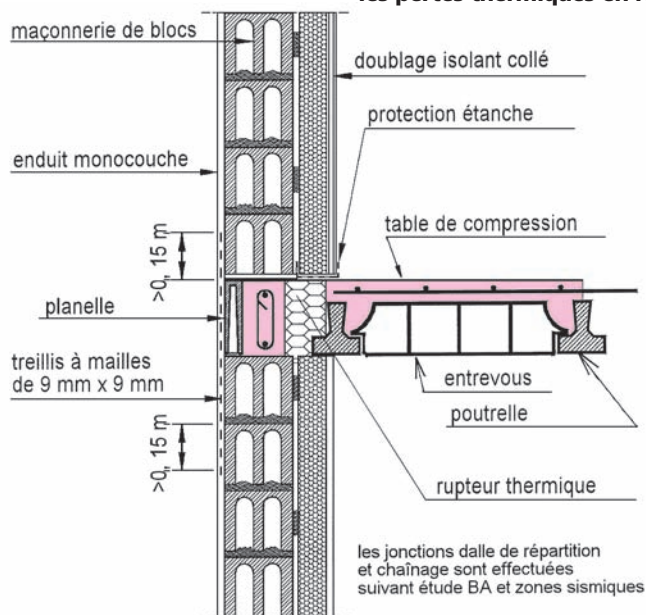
Rupteur thermique dans le cas de poutrelles parallèles au mur
